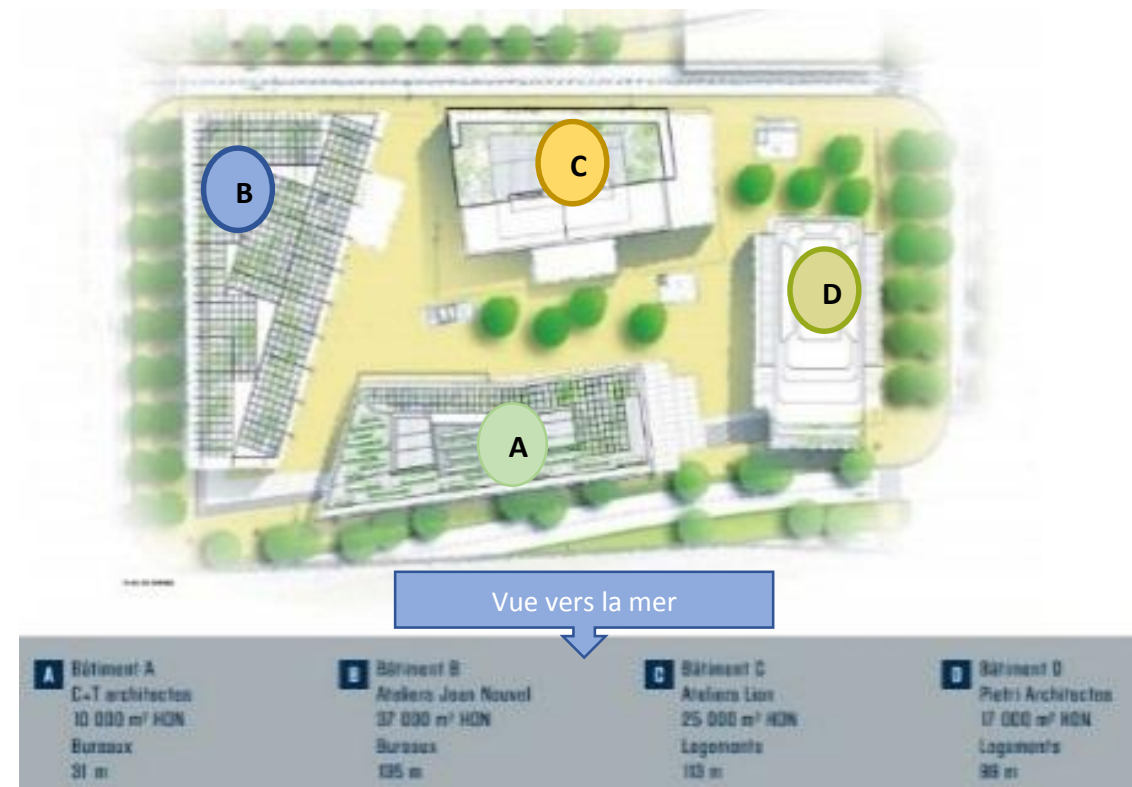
Le plan de masse du quartier d'Arenc : Hôtellerie, bureaux, logements : un projet mixte
